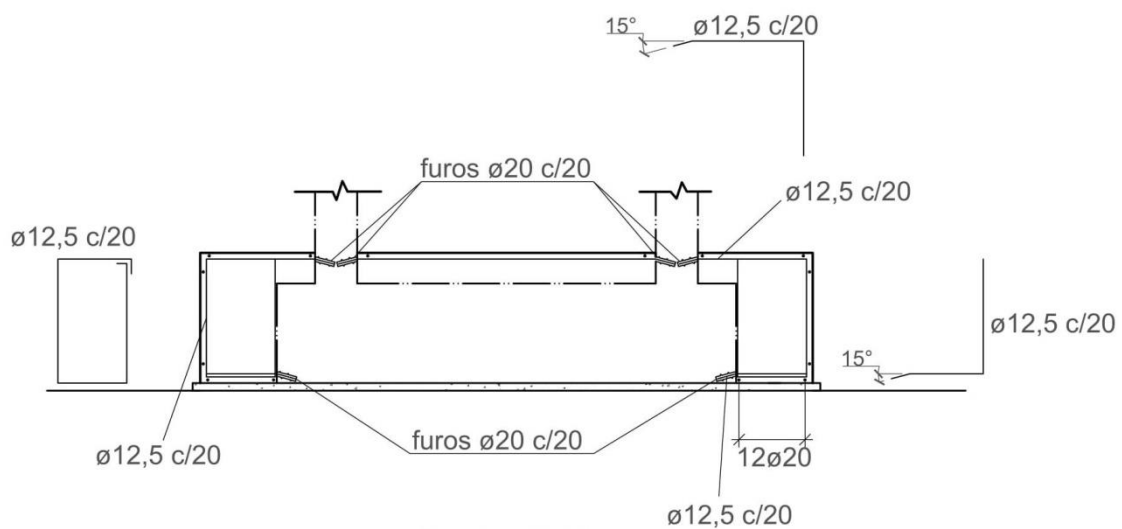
Armadura de reforço do bloco – Corte C-C (Ver Fig. 8)
